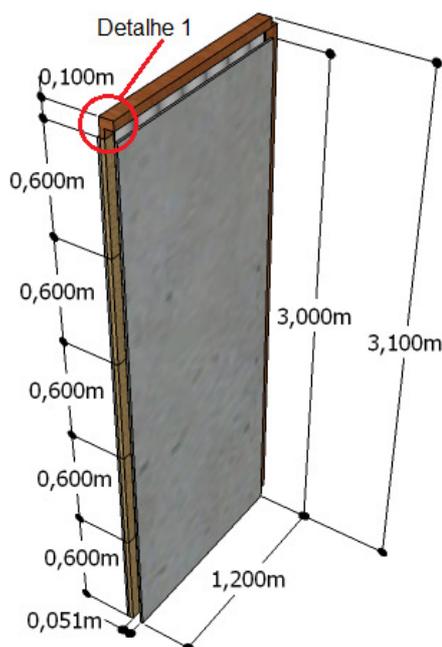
Vista geral do travamento superior da telha com a guia de madeira
